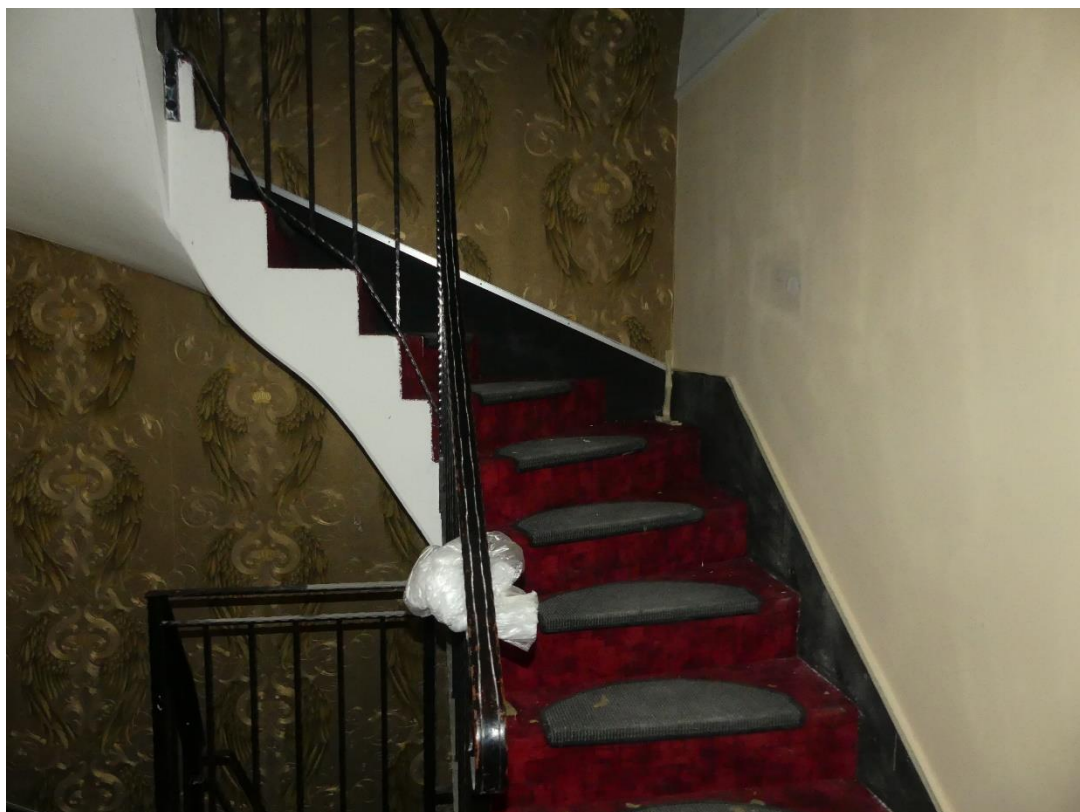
Treppe ins Mansardgeschoss/Dachgeschoss Döbelner Straße 25a
